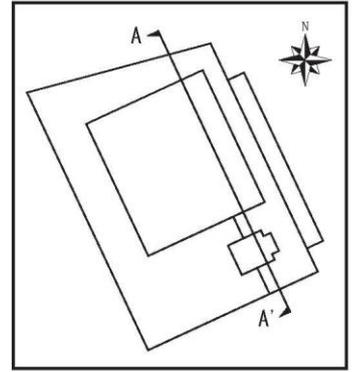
(1) 建築断面図 (東側) (完成(竣工))
